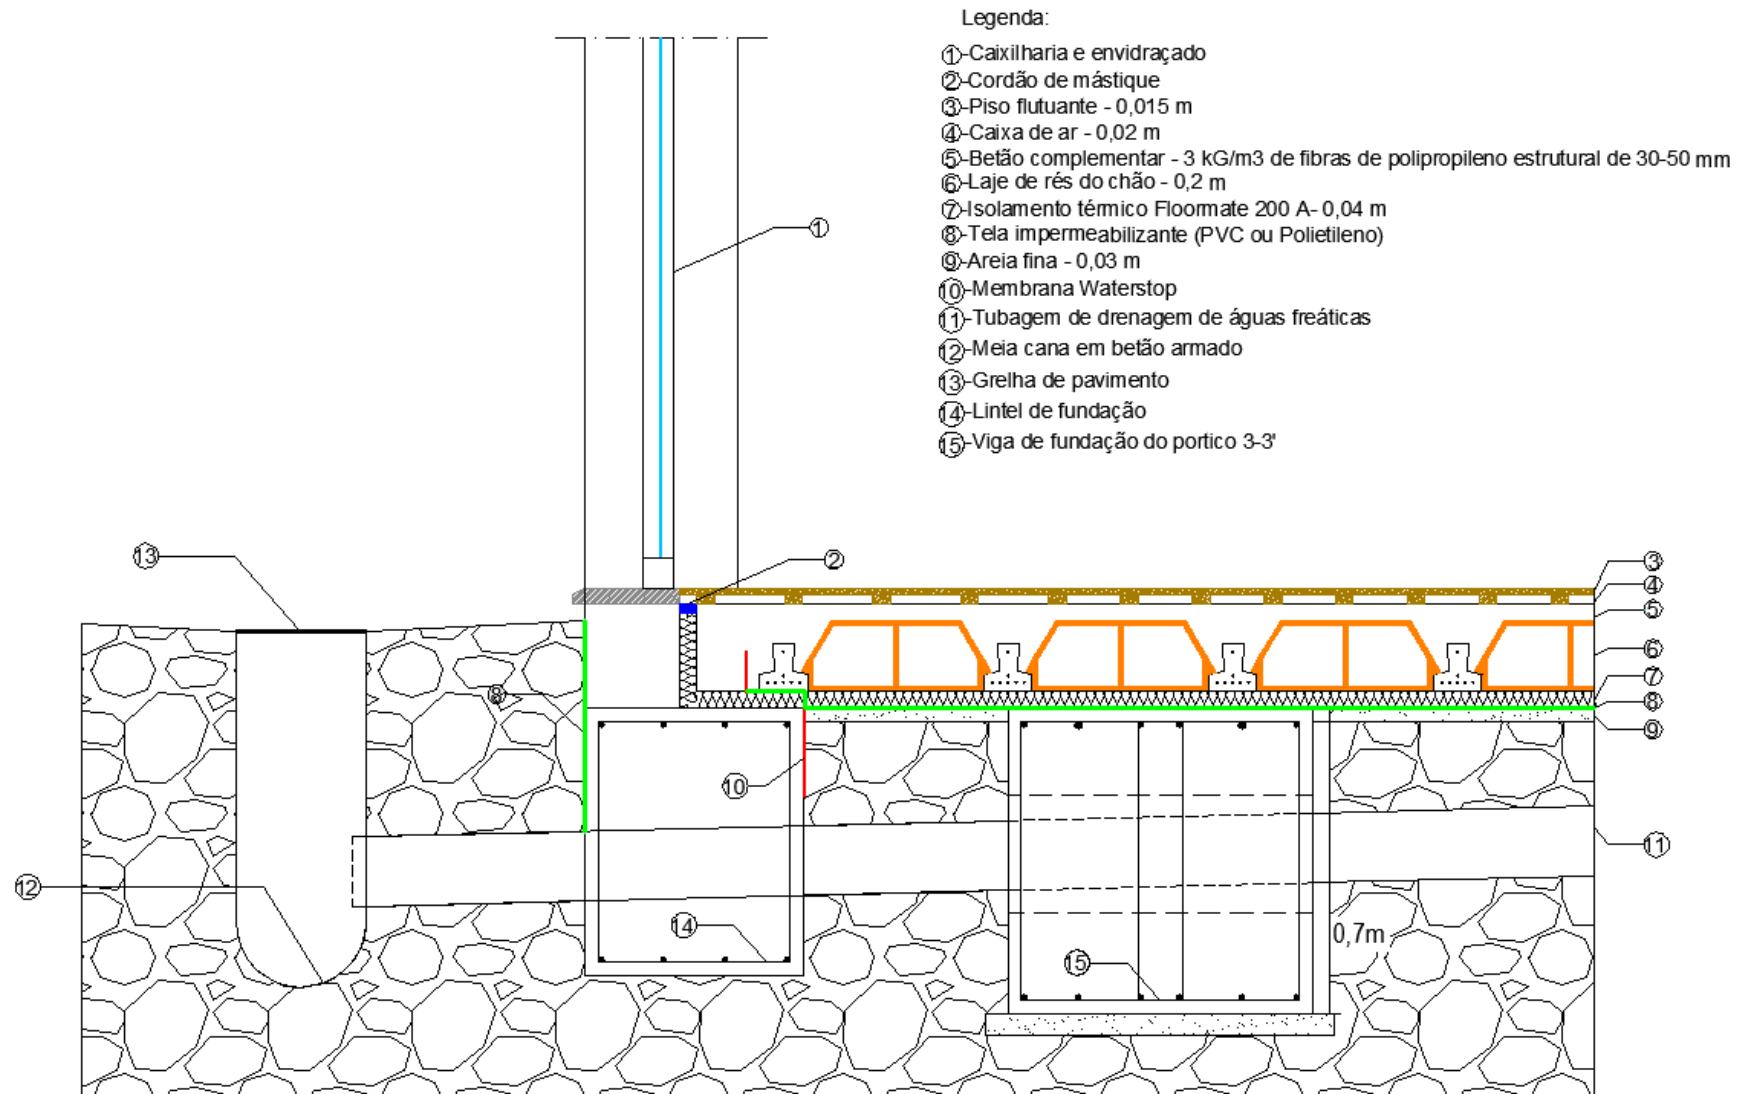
Pormenor da viga de fundação do pórtico 3-3'
